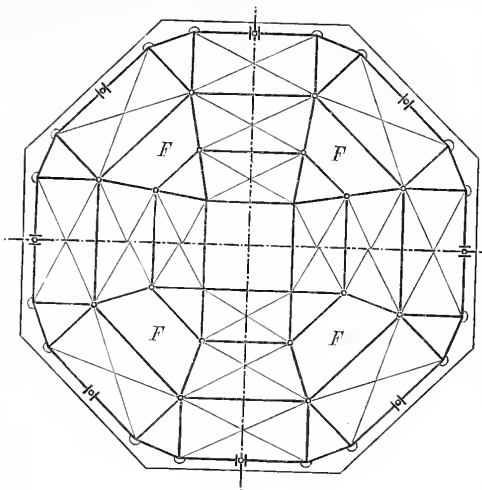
Grundriss einer dreigeschossigen Kuppel auf achteckigem Unterbau.
